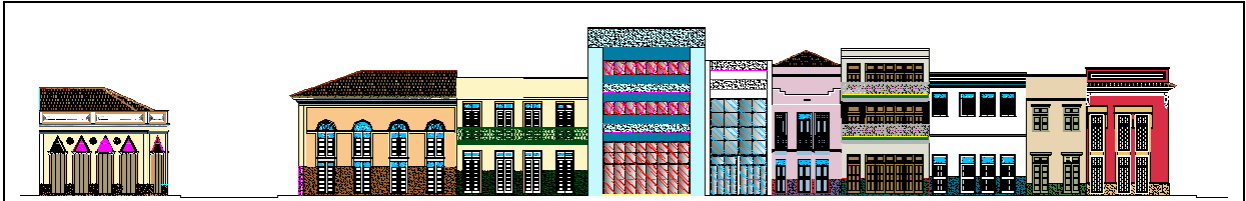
Fachadas Revitalizadas - Trecho 01 (Quadra 33) da Rua Leovegido Coelho, com propostas para as fachadas.
